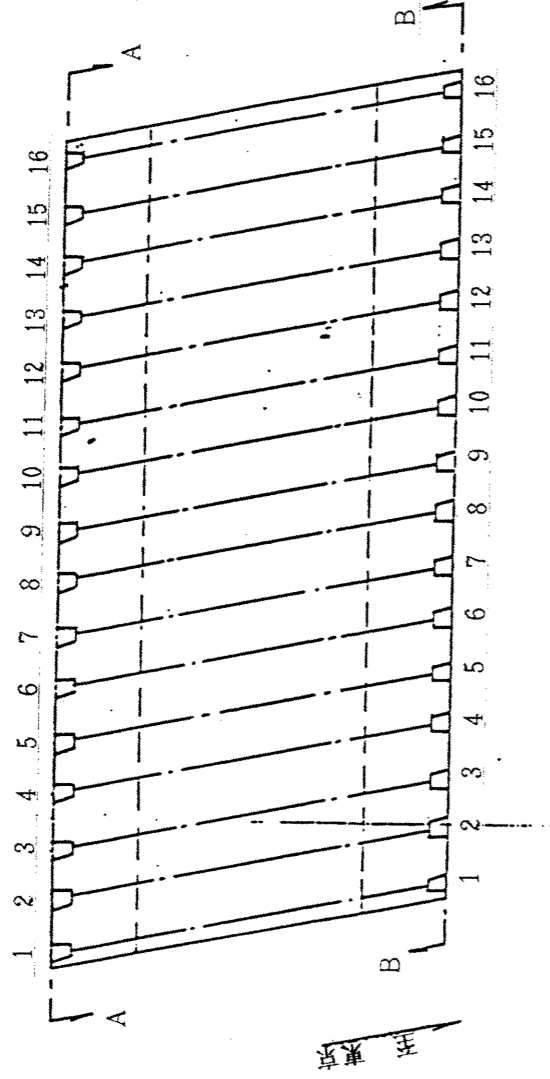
施工時ひびわれの例(橋梁橋脚)
